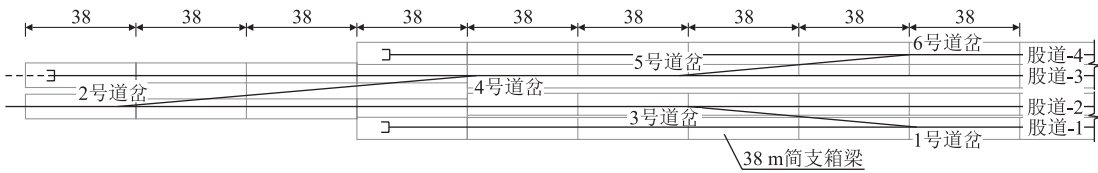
基拉里甘杰站桥梁平面布置示意图(以“道岔 1~道岔 6”范围内的梁片布置为例)(m)
